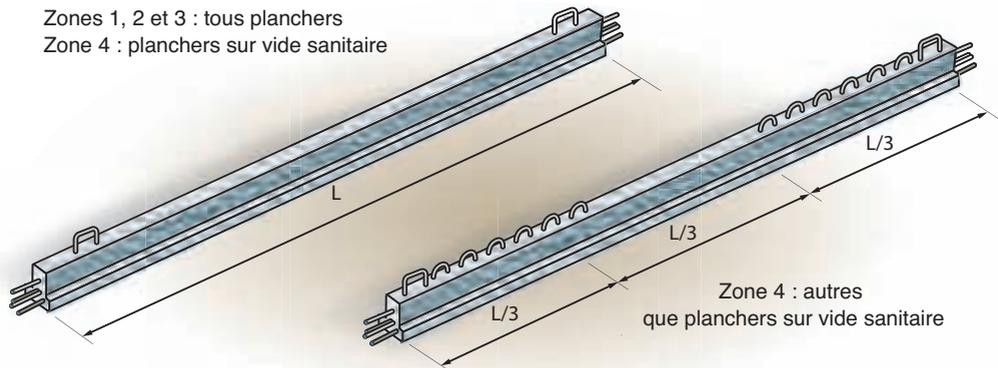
Armatures de couture des poutrelles (PSMI89)
